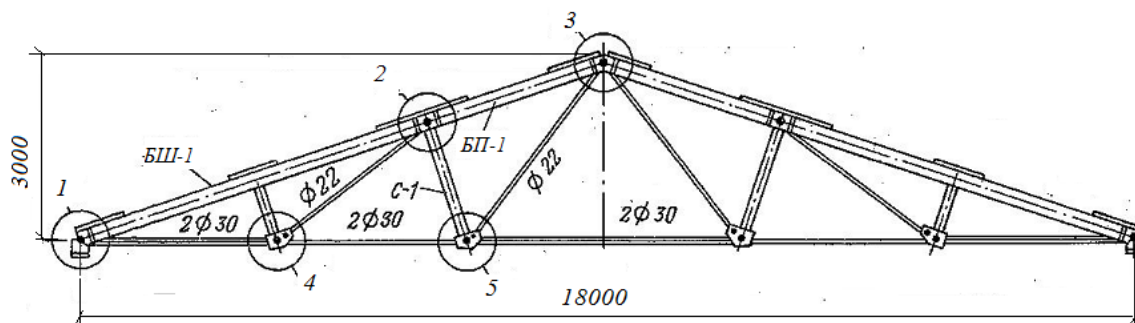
Треугольная ферма пролетом 18 м с брусчатым верхним поясом (тип-2)
